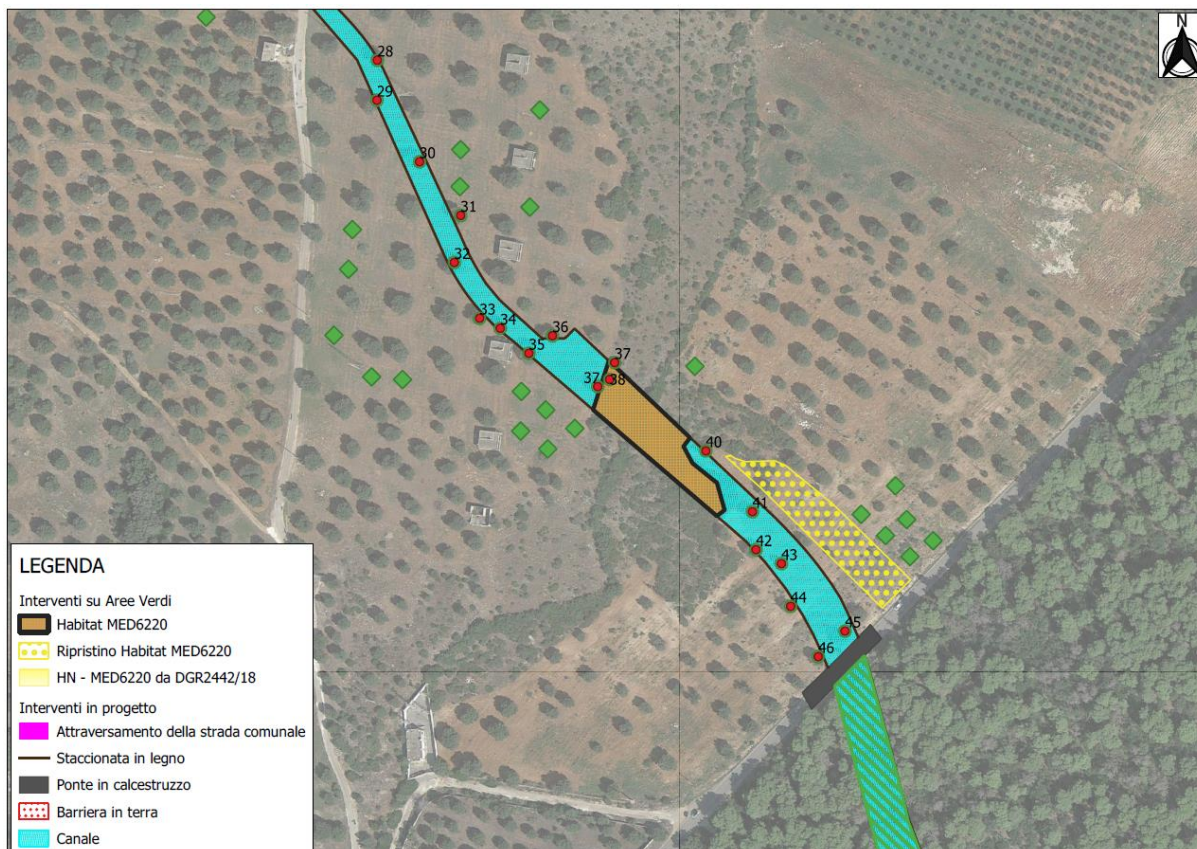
Planimetria con indicazione dell'HN-MED6220 interferente e dell'area di reimpianto
